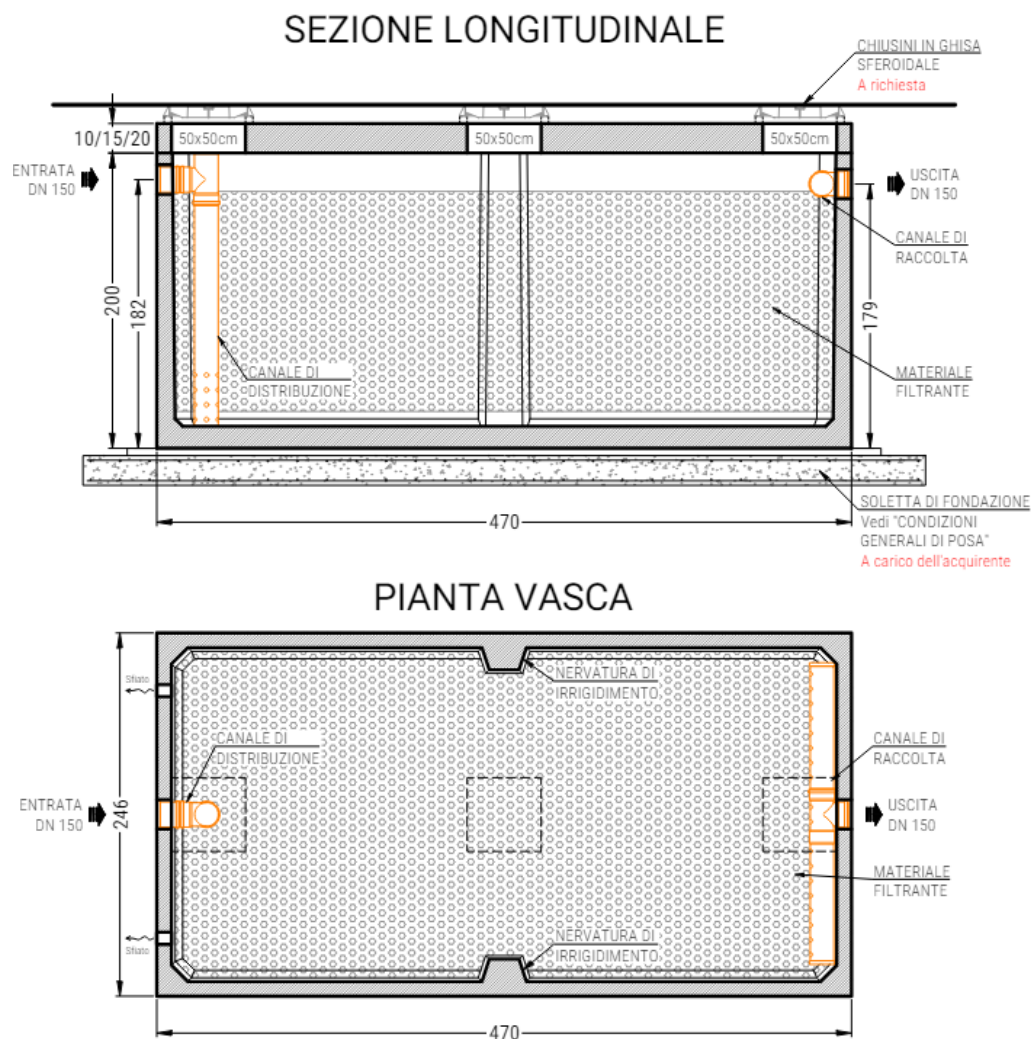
Pianta e sezione trasversale tipo del filtro percolatore anaerobico pref. prevista a progetto.
